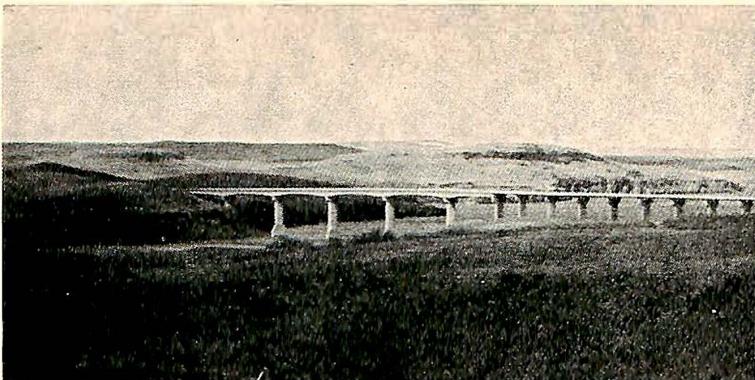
Det virker nokså grunnløst å endre konstruksjonen til betongbrua på høyre side.
